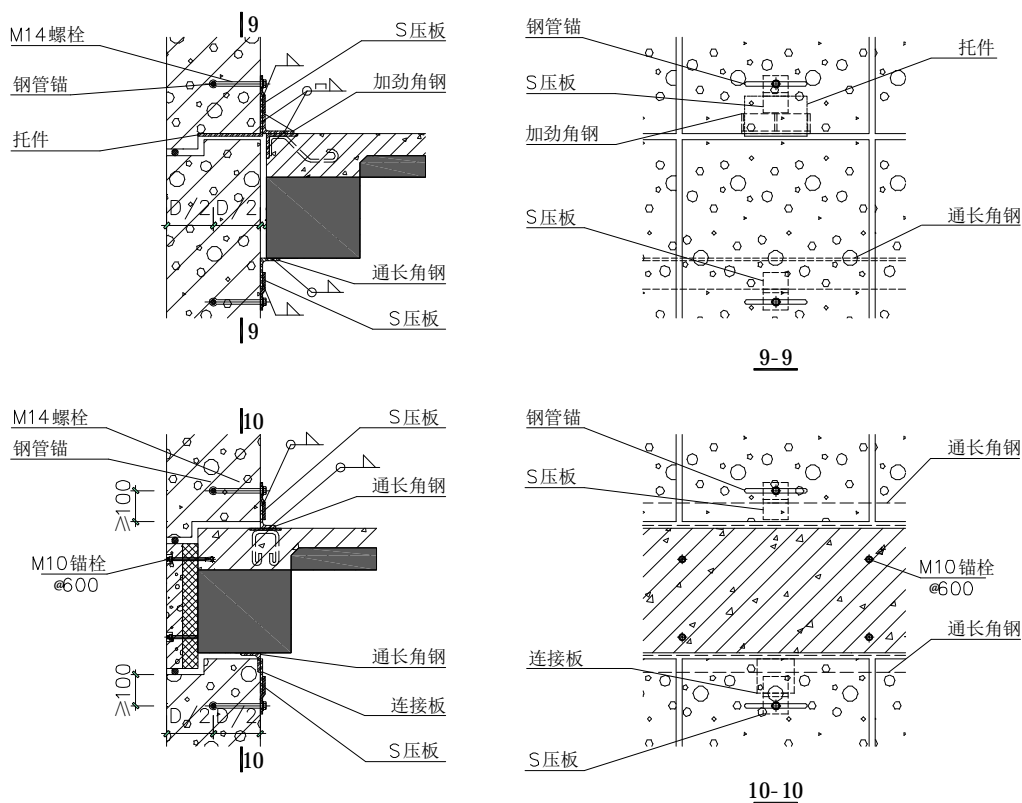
钢筋混凝土结构 AAC 板外墙钢管锚节点
